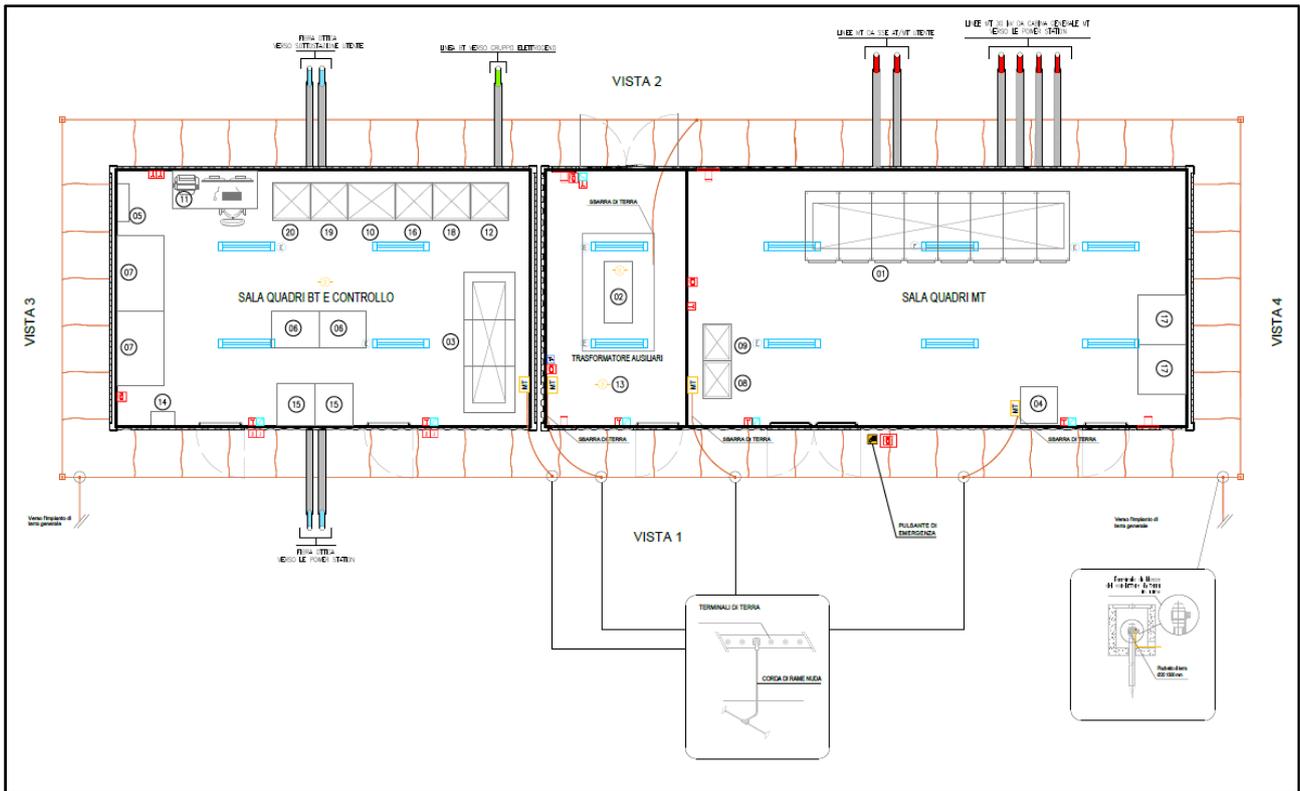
Cabina elettrica e di smistamento. Pianta
